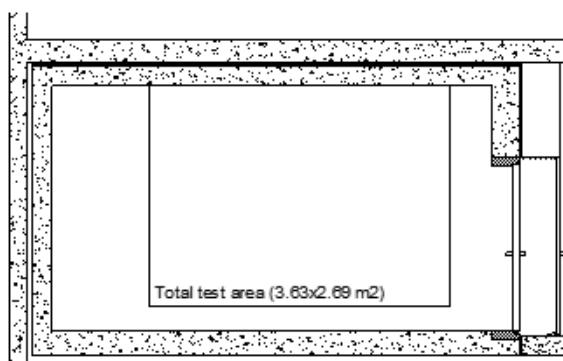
Vista em corte BB' das câmaras reverberantes do DEC-UC com a zona de montagem de provetes assinalado
